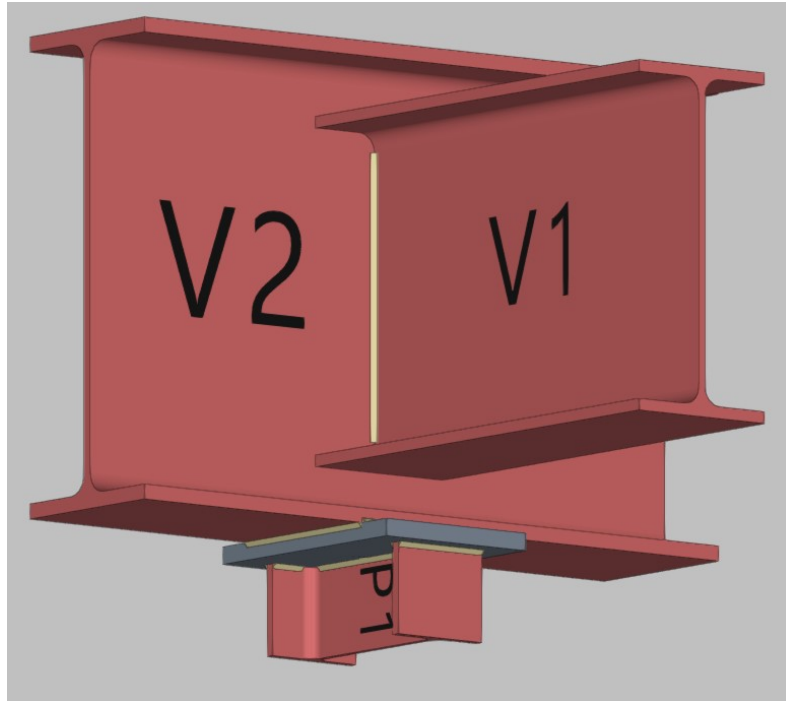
“Unión 6. Intento de apoyo de viga en pilar. CYPE Connect. Fuente: Propia.”
